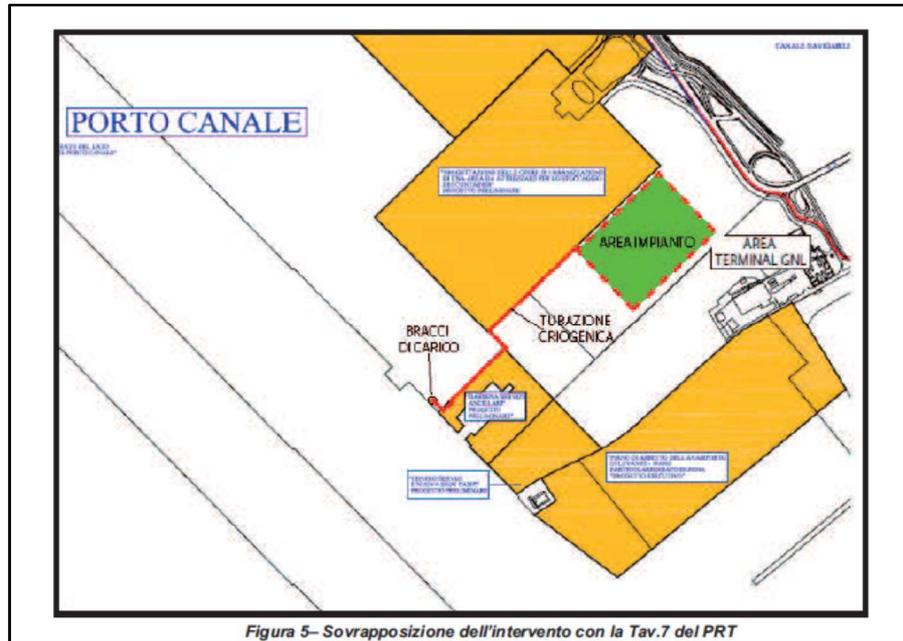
Stralcio Tav. 7 PRT con sovrapposizione aree impianto
